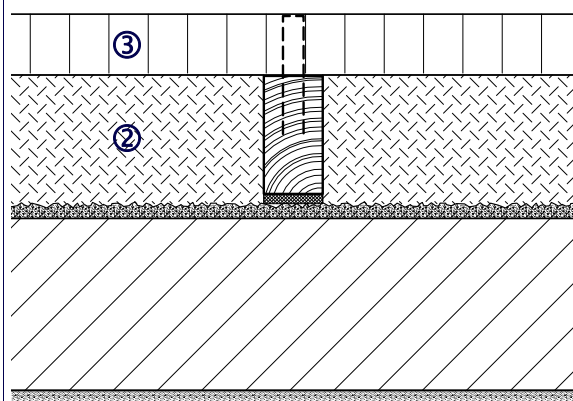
Erläuterungen zum Konstruktionsaufbau (Vertikalschnitte)
